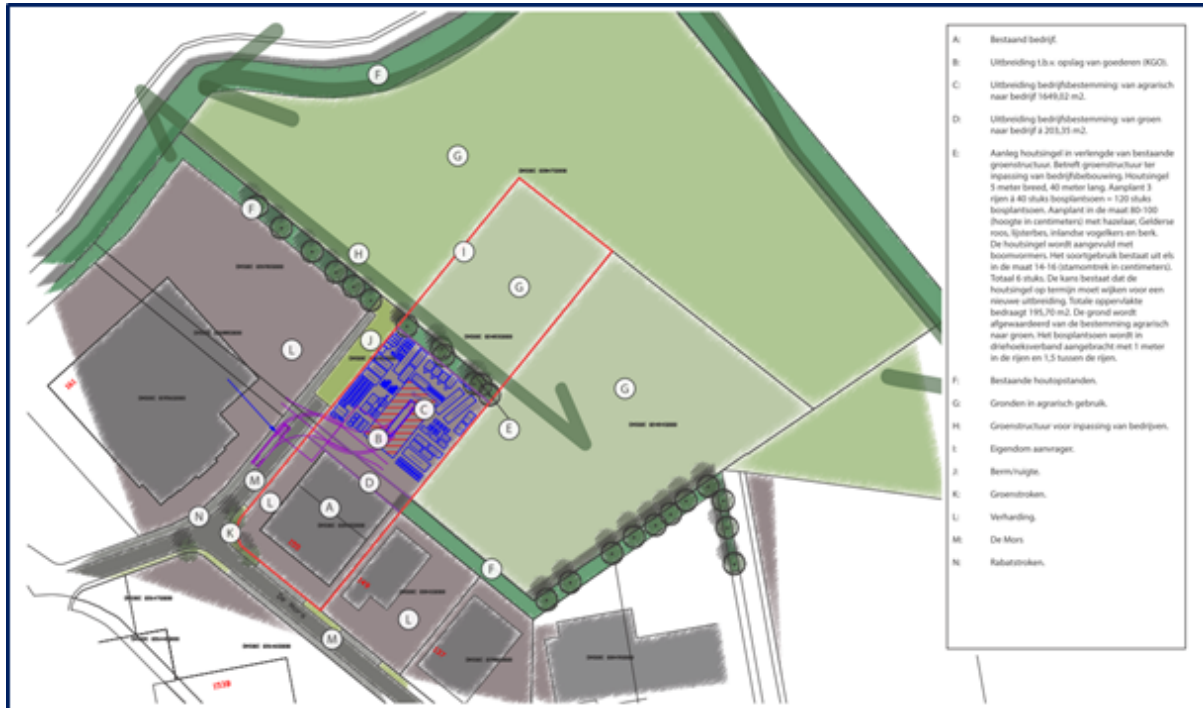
situatie bij opslag op terrein aan west- en voorzijde (bron: Architom architecten)
